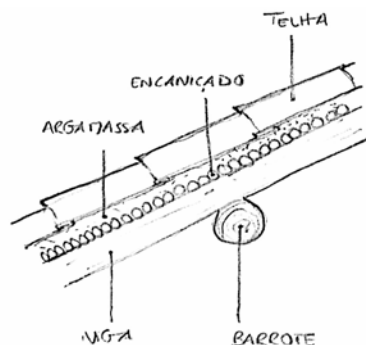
Corte esquemático de sistema construtivo tradicional: telhado de telha argamassada com “encançado”. (Ilustração Nossa, 2017)
